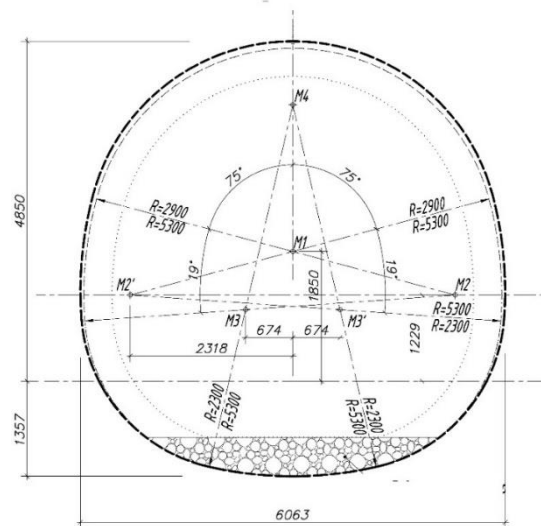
Габарит наближення будівель перегінного тунелю
